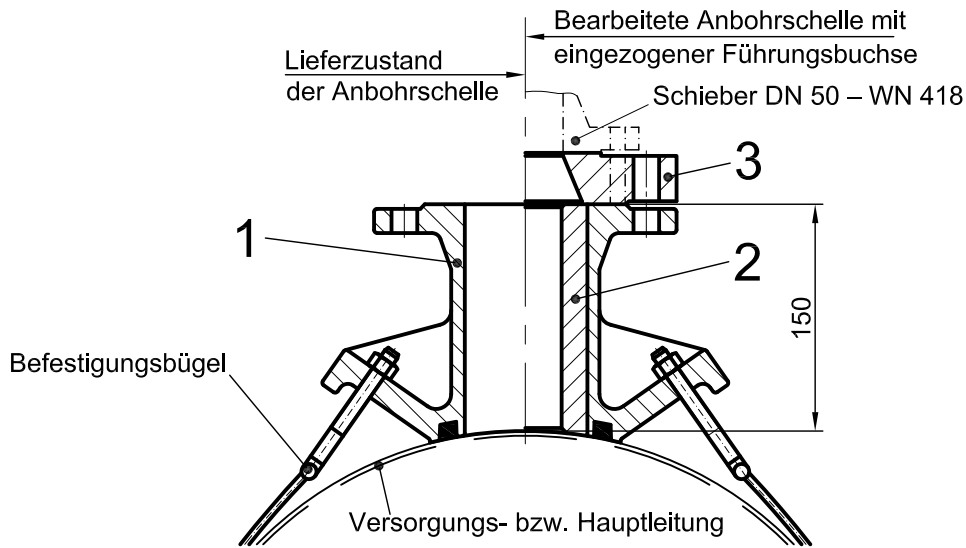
Flanschbohrschelle an Gussleitungen (Prinzipskizze)
